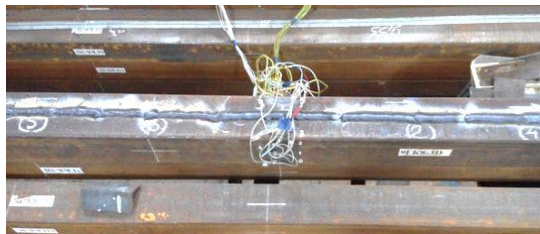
Правка элементов путем наплавки валиков сварных швов на растянутой стороне образцов
